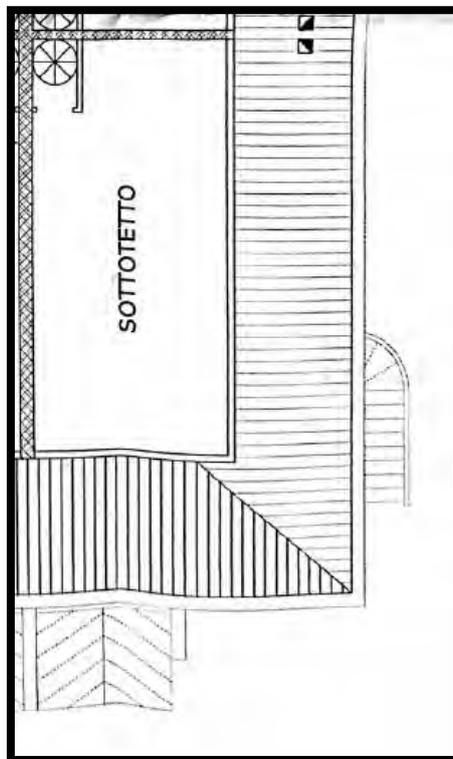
Pianta piano sottotetto allegata alla CILA prat. n. 294/2011
